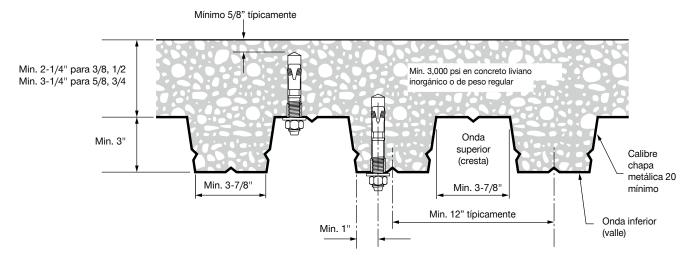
Instalación de Kwik Bolt VTZ en losas compuestas sobre chapa metálica
